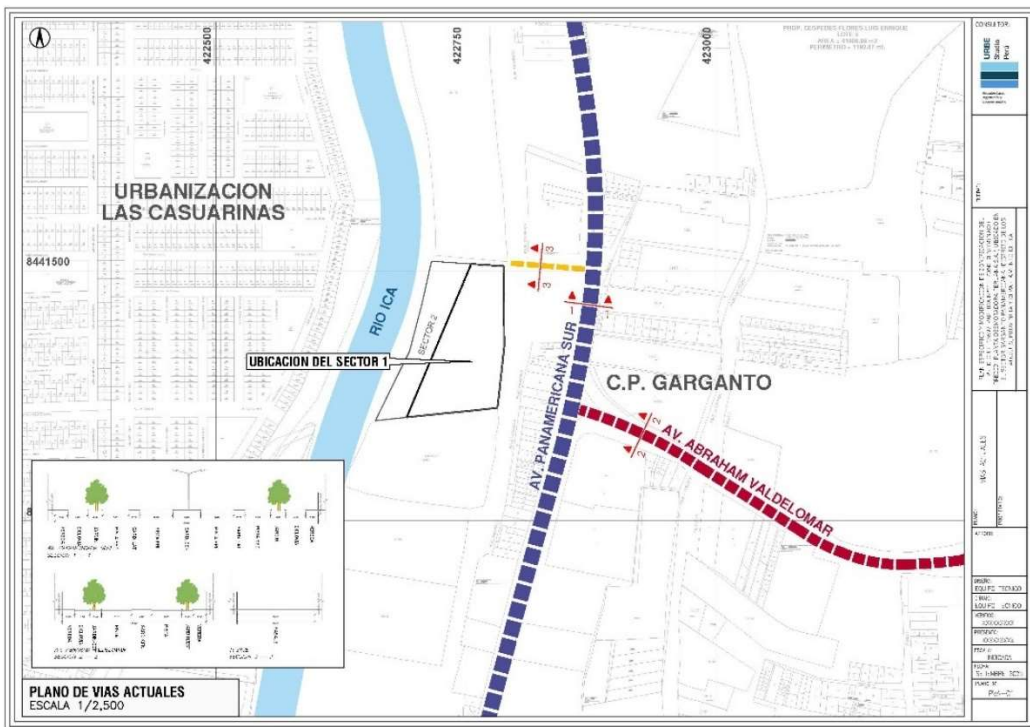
PLANO DE VIAS -SECTOR 1
